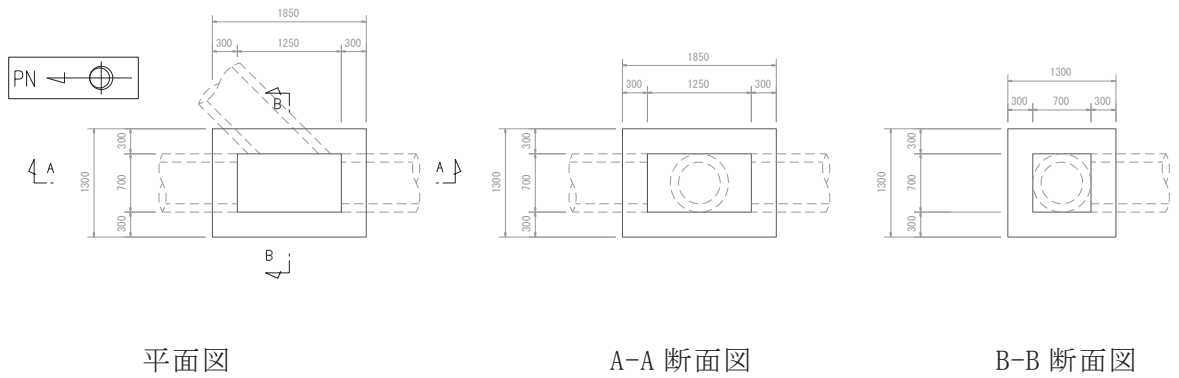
(1) 接続柵構造概要図 (単位 : mm)
